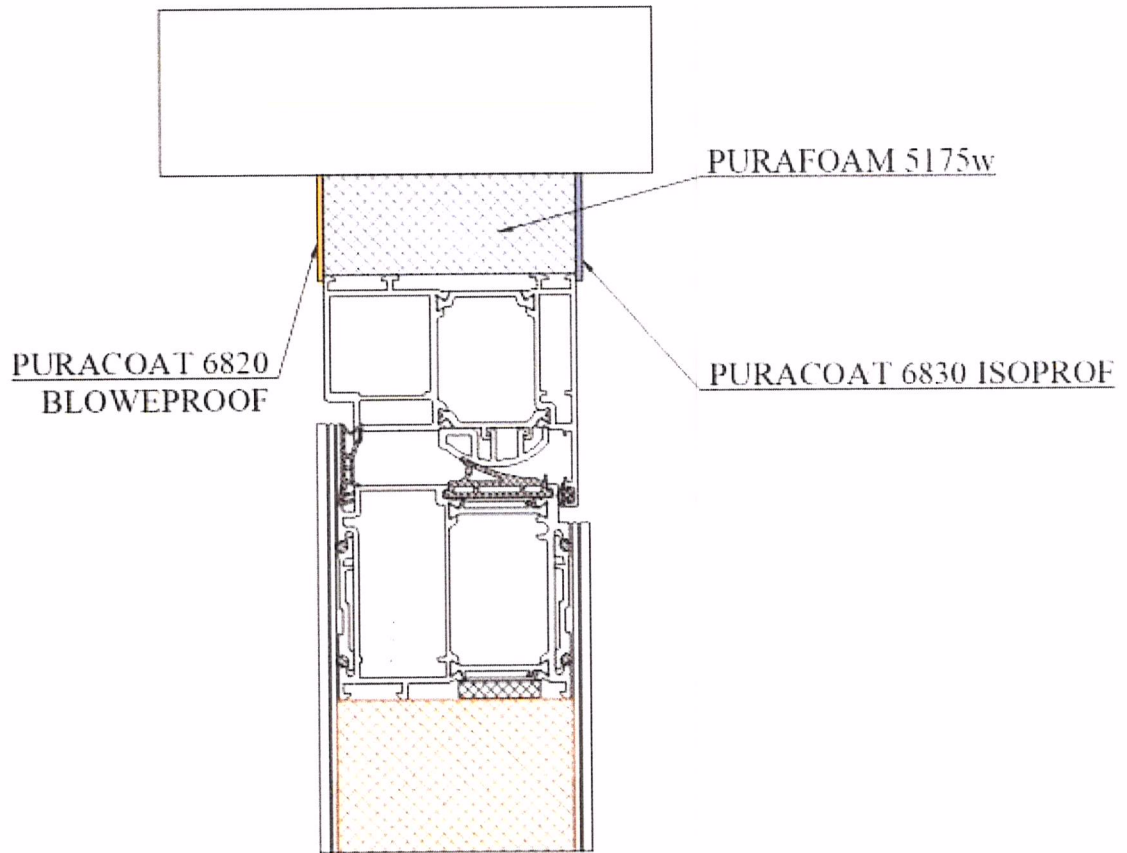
Схема устройства верхнего и бокового монтажного шва образца 453-24/2
